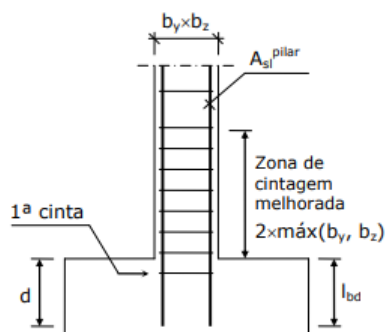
Pormenor da inserção da armadura do pilar (Félix et al., 2013).
